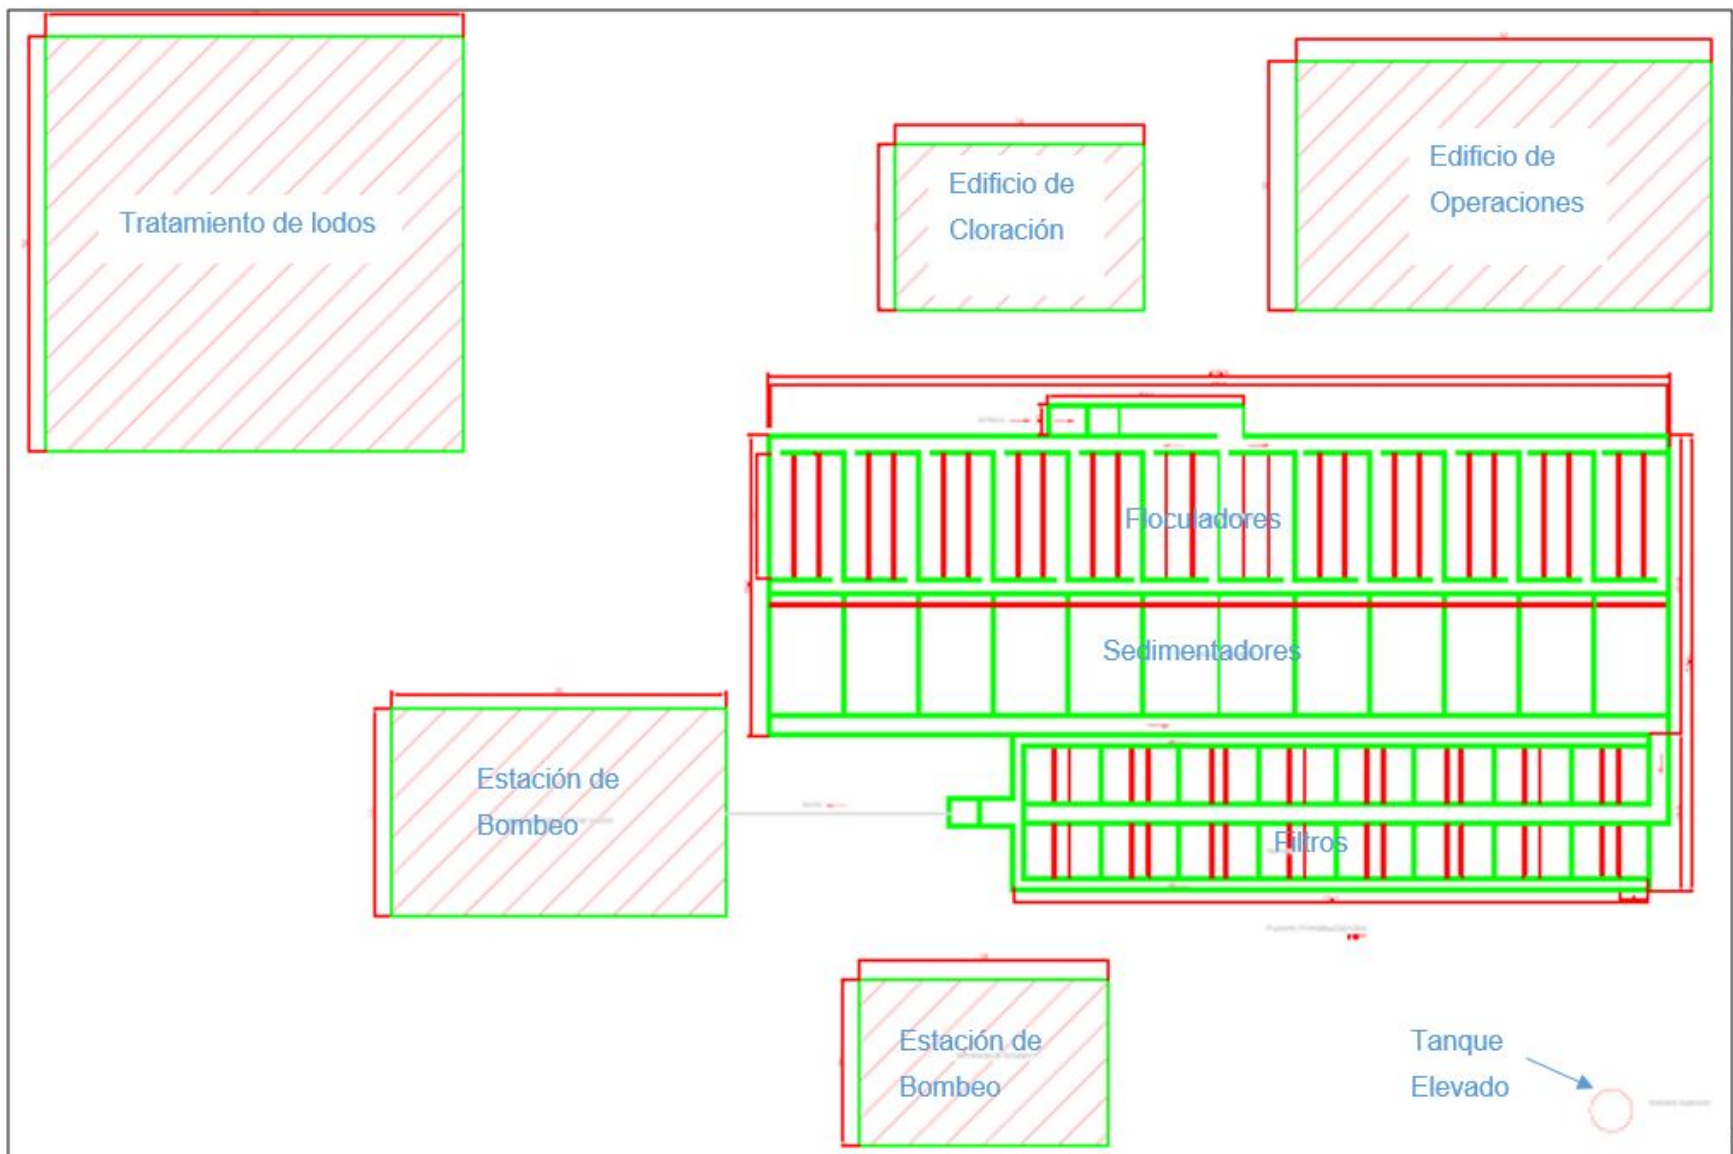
Esquema de la Planta Potabilizadora – Ampliación del Acueducto Metropolitano. Fuente : Elaboración propia (2017)
